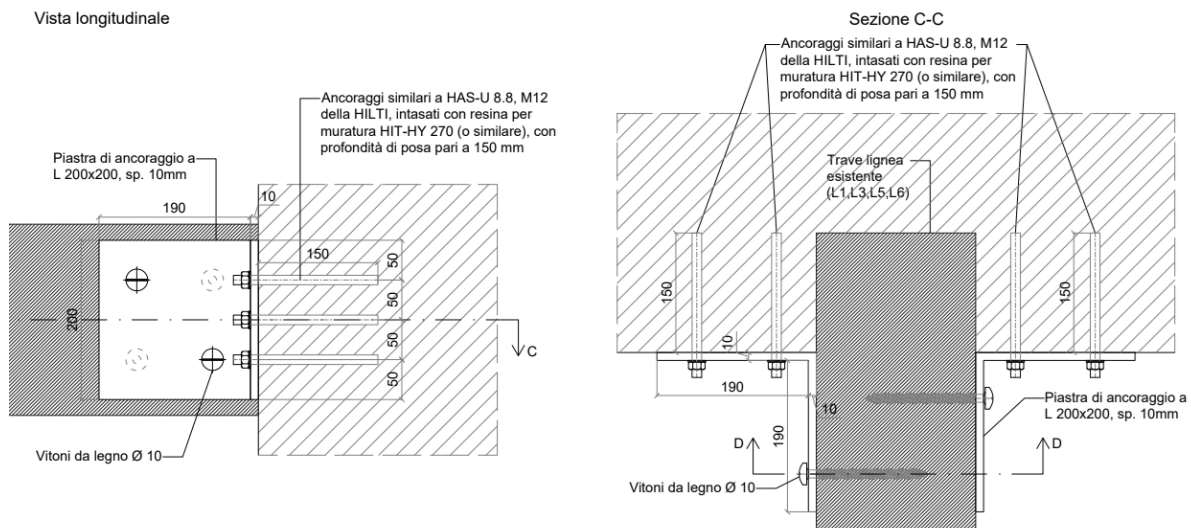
ancoraggio delle piastre di collegamento trave-muratura per ripristinare il collegamento di un impalcato di legno alla struttura portante (disegno tecnico da progetto di un ordine di servizio per la messa a norma del Palazzo San Felice a Pavia, lavori di Studio Calvi BEAM).
